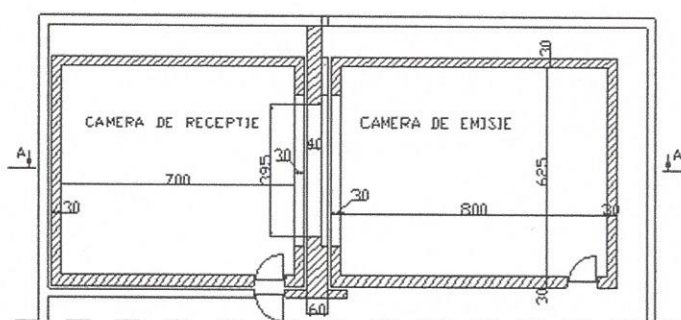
b. - Plan stand de măsurări pentru izolare la zgomot aerian
